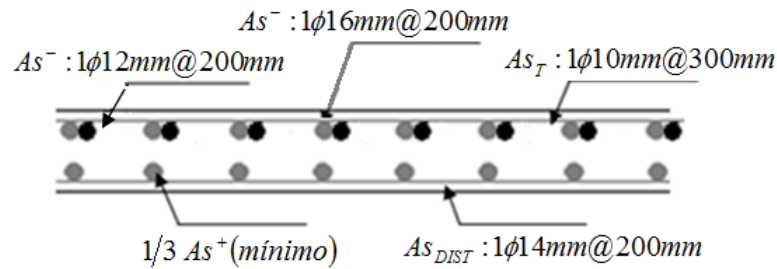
Armado en tablero (losa-voladizo) corte longitudinal
